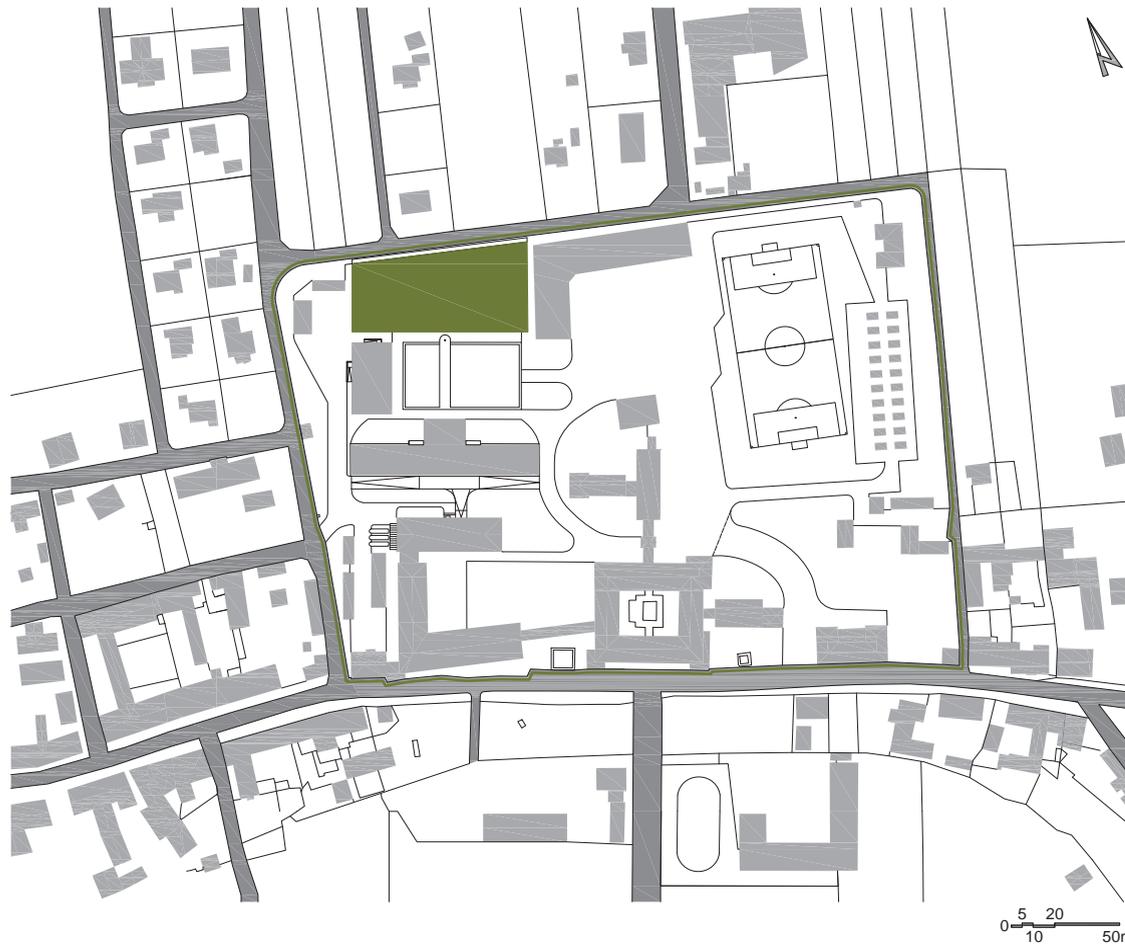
Planungsgebiet mit bestehender Gebäudestruktur und öffentlichen Verkehrsflächen M 1:3500
